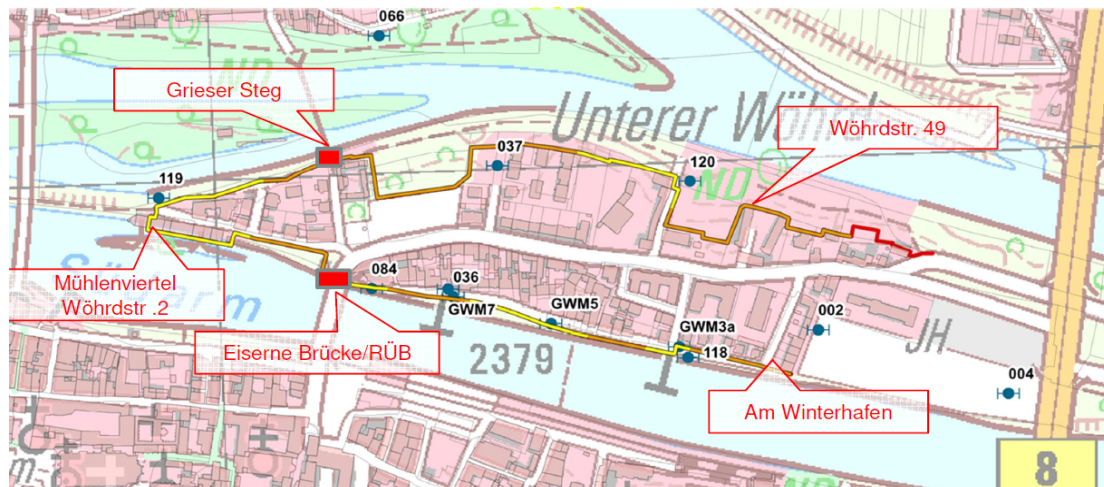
Trasse der Untergrundabdichtung mit planmäßigen Öffnungen
